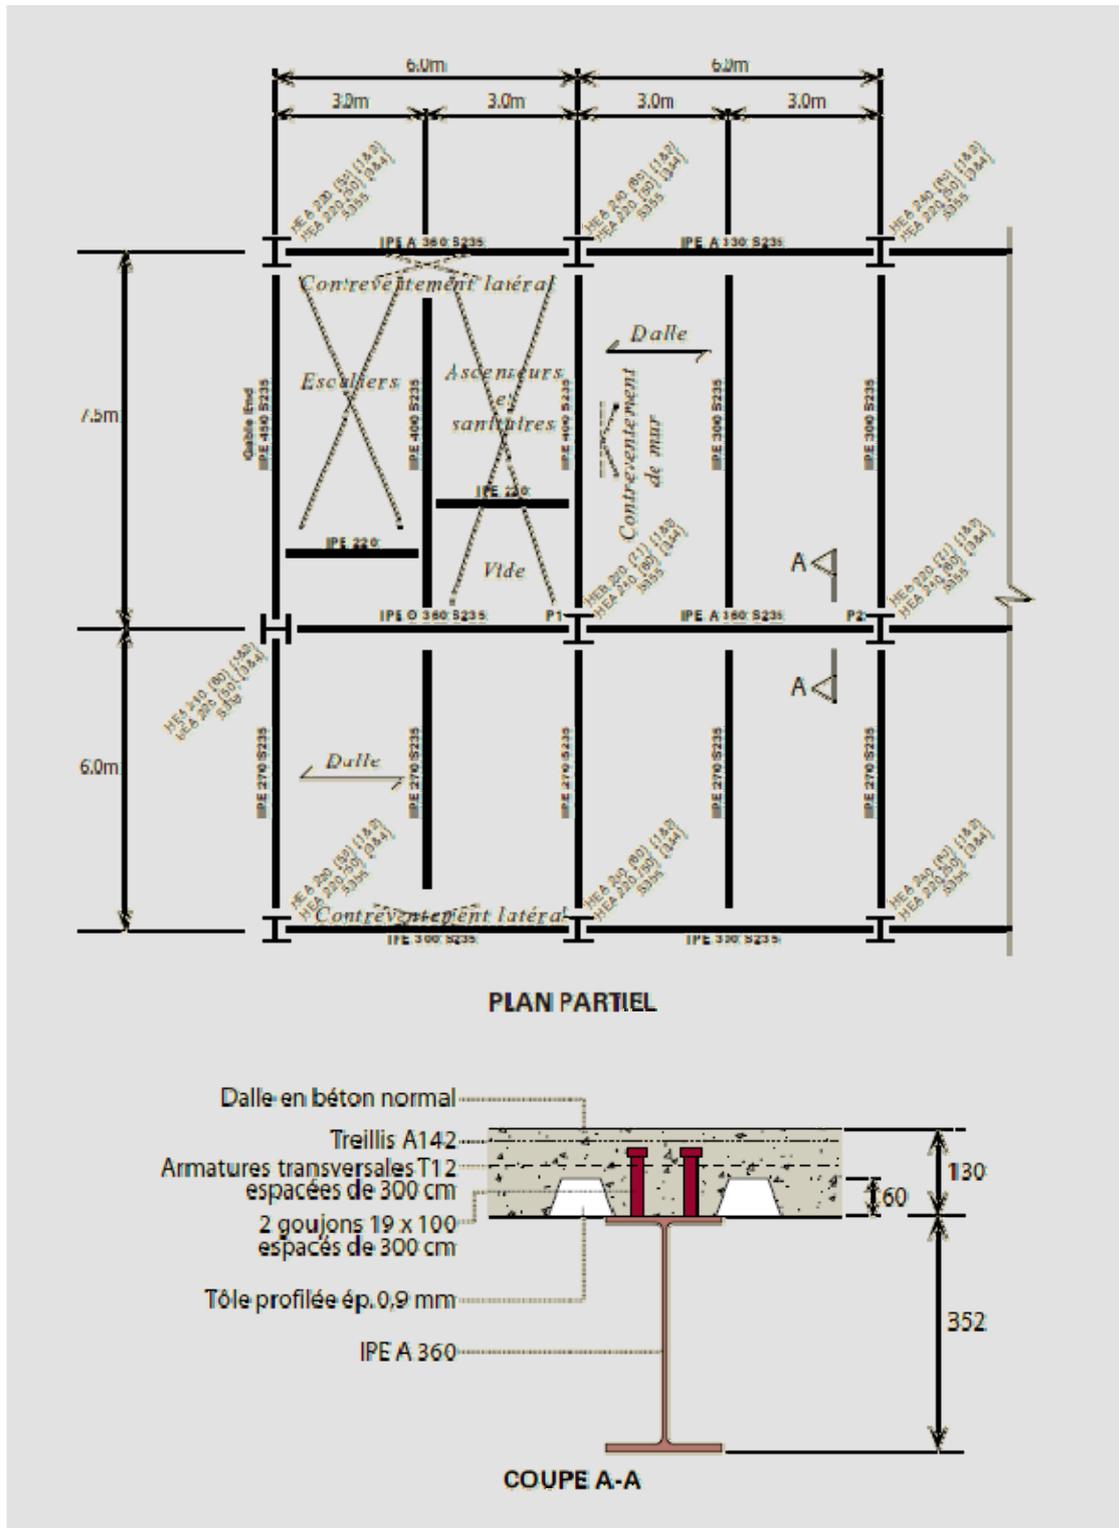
Poutre mixte de faible portée – Exemple de configuration de plancher en acier pour un bâtiment de 4 étages à trame rectangulaire
